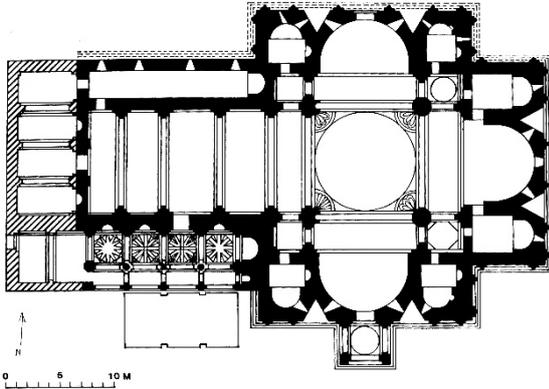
Grundriss der Kirche von Öşk Vank (nach Djobadze 1992, Fig. 27).
